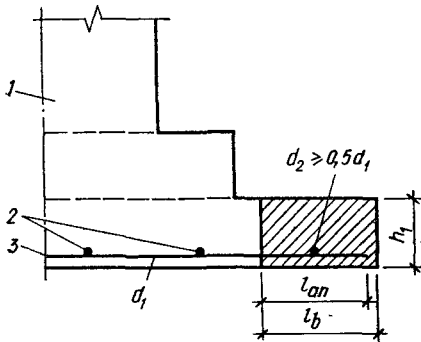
Анкеровка рабочей арматуры подошвы фундамента (второй слой сеток условно не показан):
